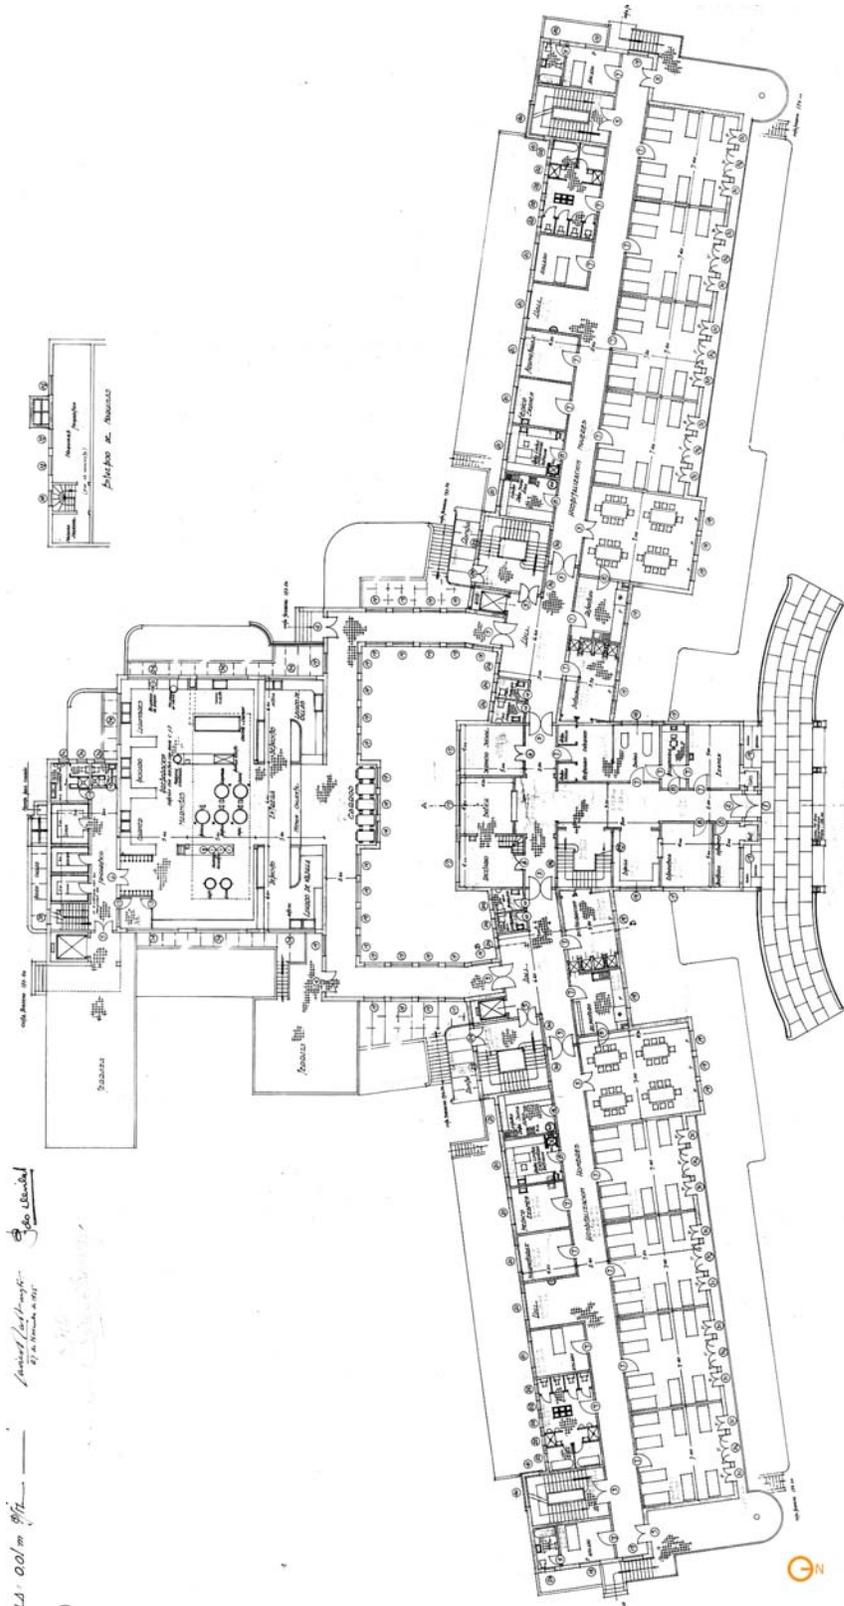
Planta del primer piso. Fuente: escaneo de la planimetría del proyecto original de 1935. Toda la planimetría proviene de la misma fuente. Las intervenciones en color son del autor
